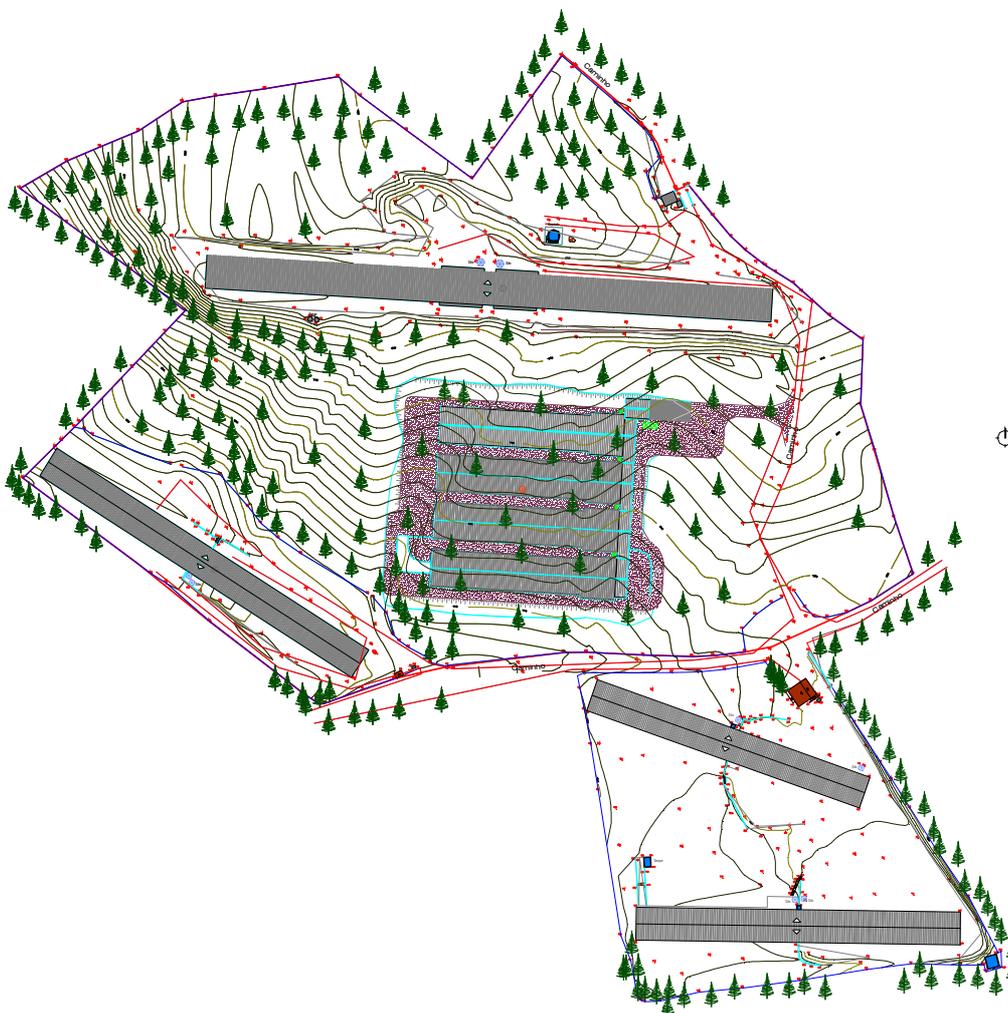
PLANTA GERAL DA PROPRIEDADE VISADA. ÁREA A EDIFICAR ASSINALADA A LILÁS.
